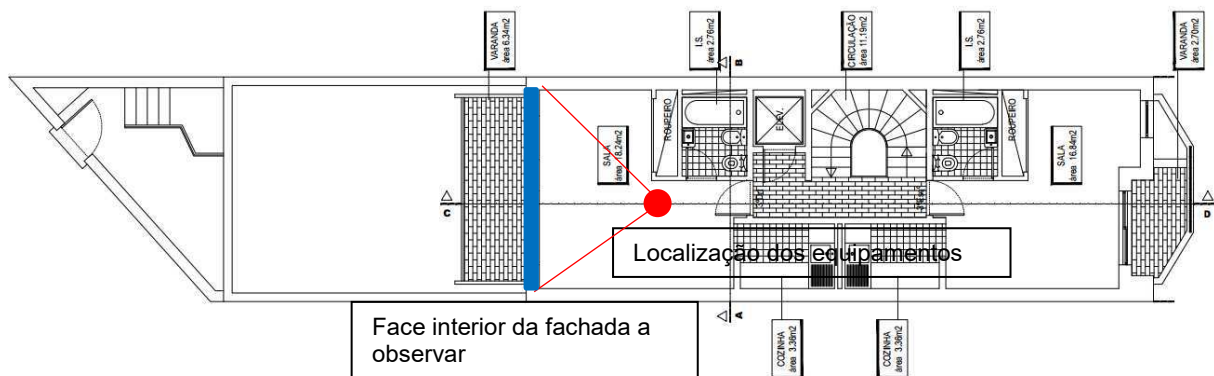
Estudo da localização e posicionamento dos equipamentos sobre a planta do edifício (elaboração própria)
